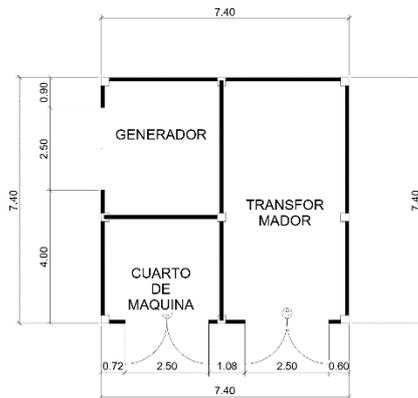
Planta Arquitectónica\_ Área de Servicios.
